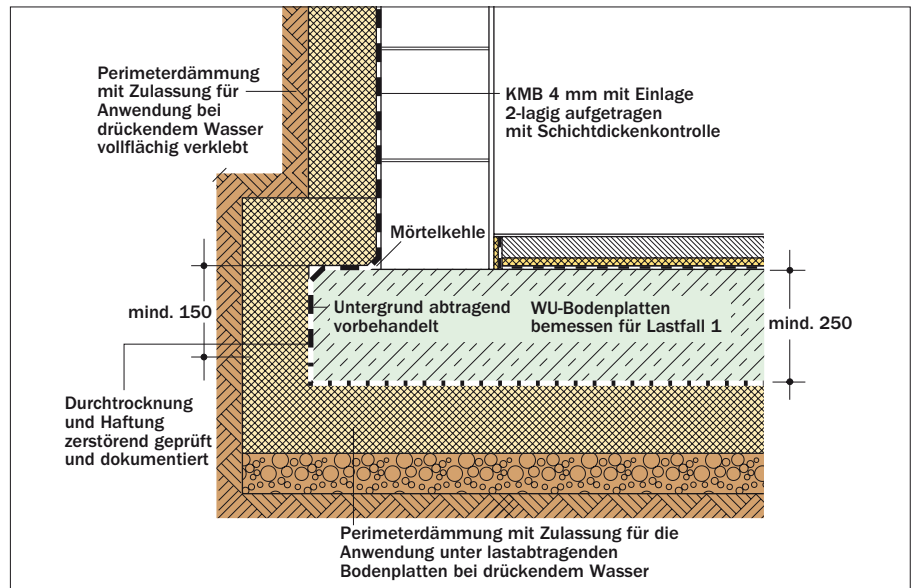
Übergang zwischen Wandabdichtung aus KMB und WU-Beton-Bodenplatte bei stauendem Sickerwasser
